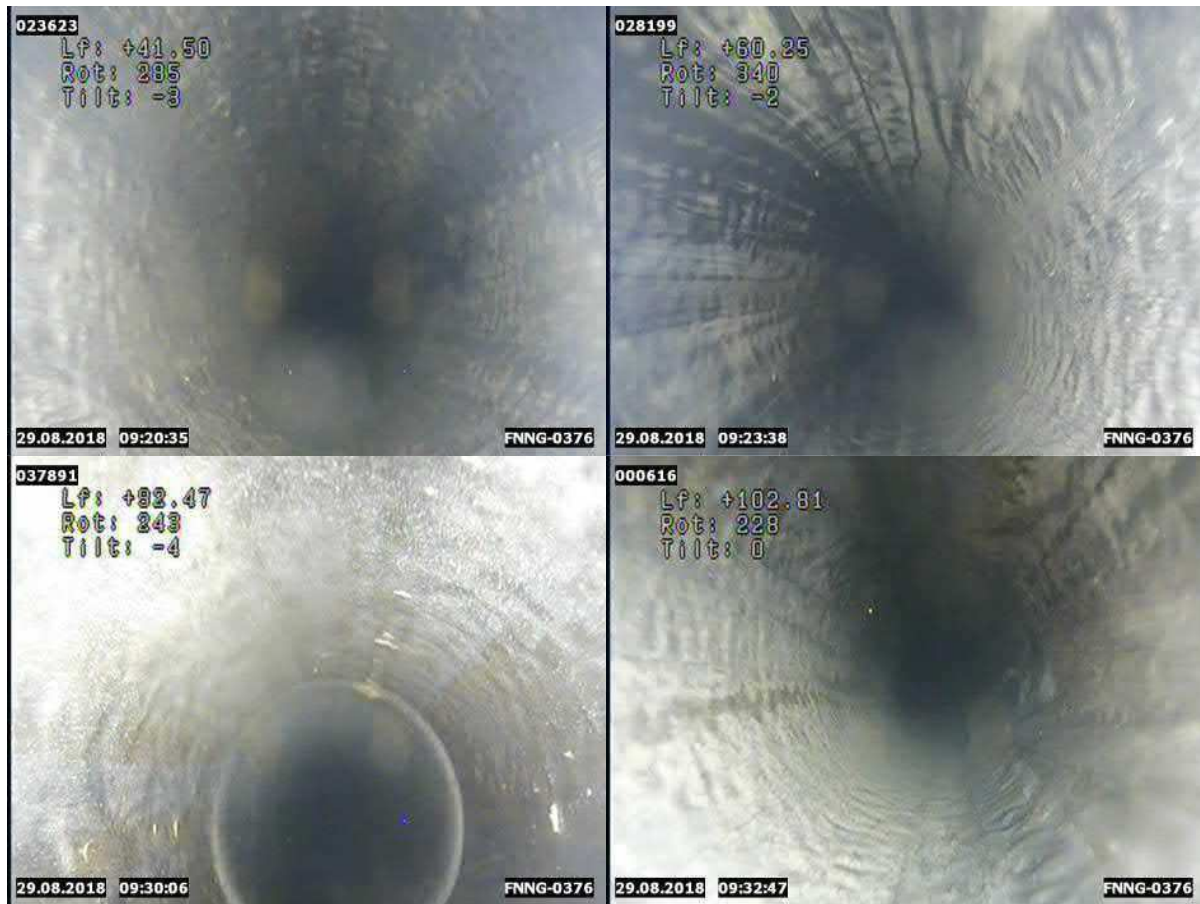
Zone immergée : parois propres du tubage PVC plein
